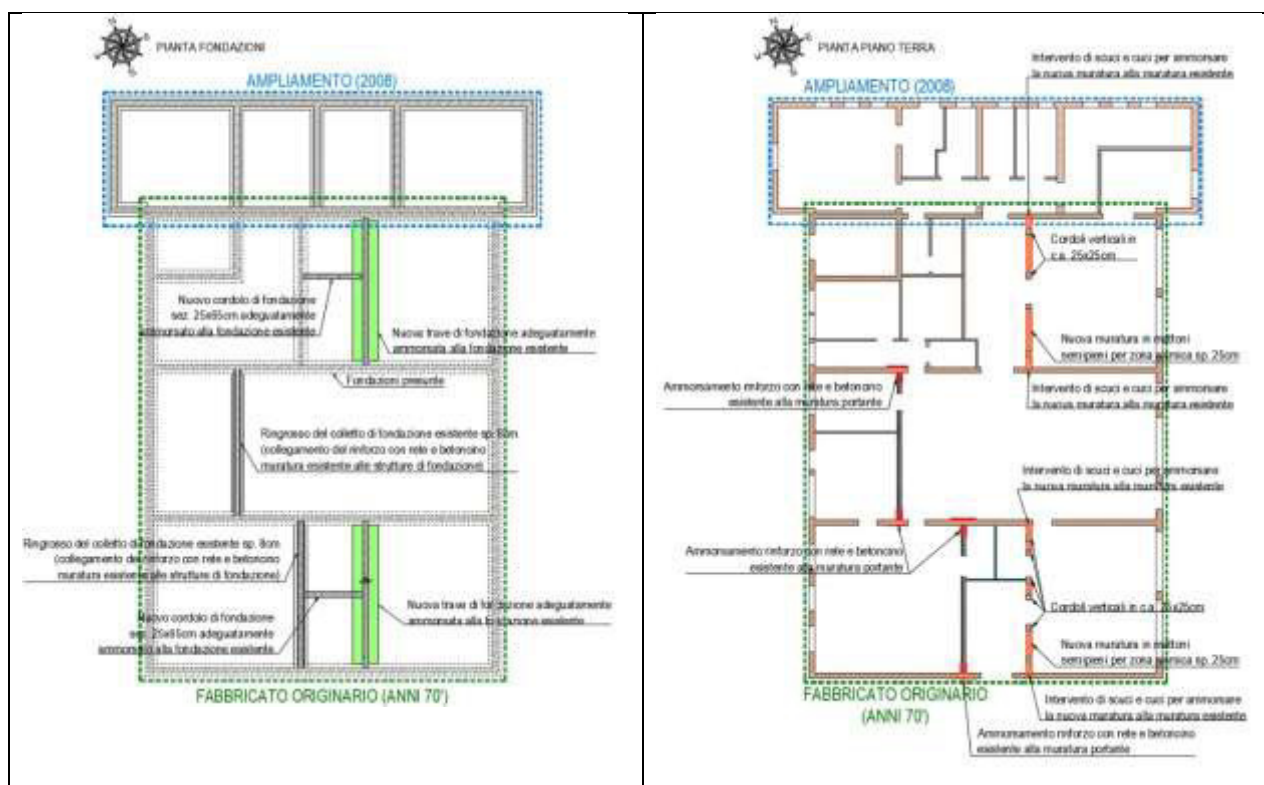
Pianta fondazioni e piano terra con descrizione degli interventi previsti in progetto
